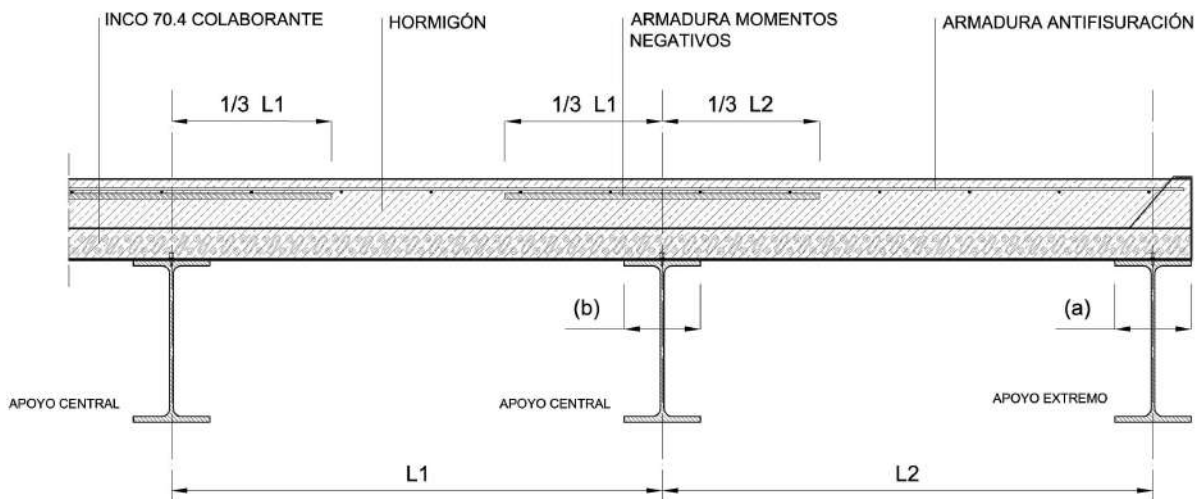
"Disposición de las armaduras de negativos sobre apoyos intermedios y extremo"
